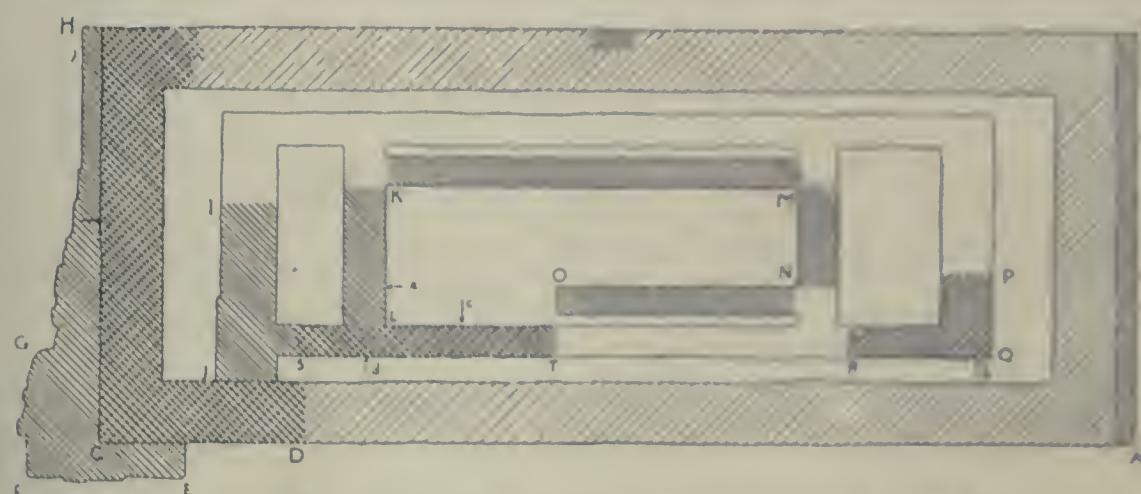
Plan schématique des fondations du temple (Largeur AB = 57' 82').
